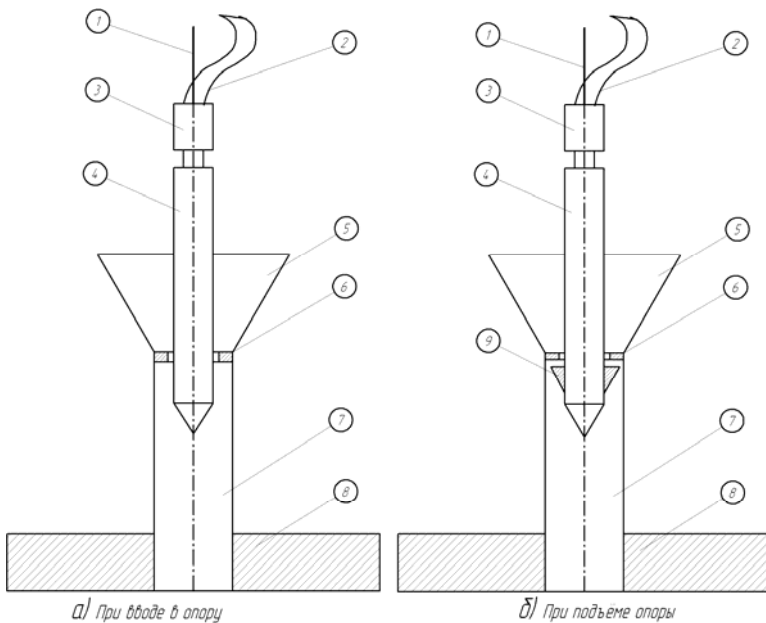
Схема работы ловителя: 1-трос; 2-нагнетательный шланг; 3- грузовой переводник; 4-ловитель; 5- раструб; 6 – фланец; 7 –наружная труба; 8 – основание; 9- захваты.
